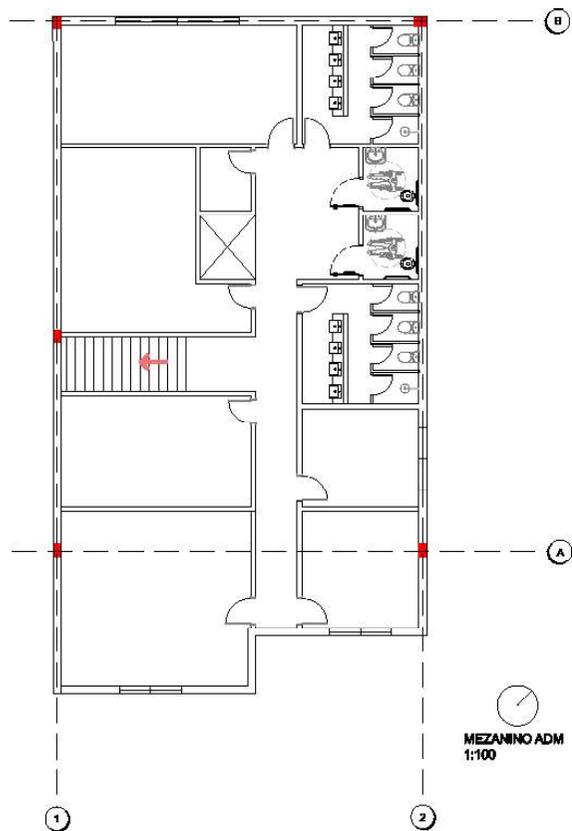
Planta estrutura mezanino - 1:100 - Desenvolvido pela autora
